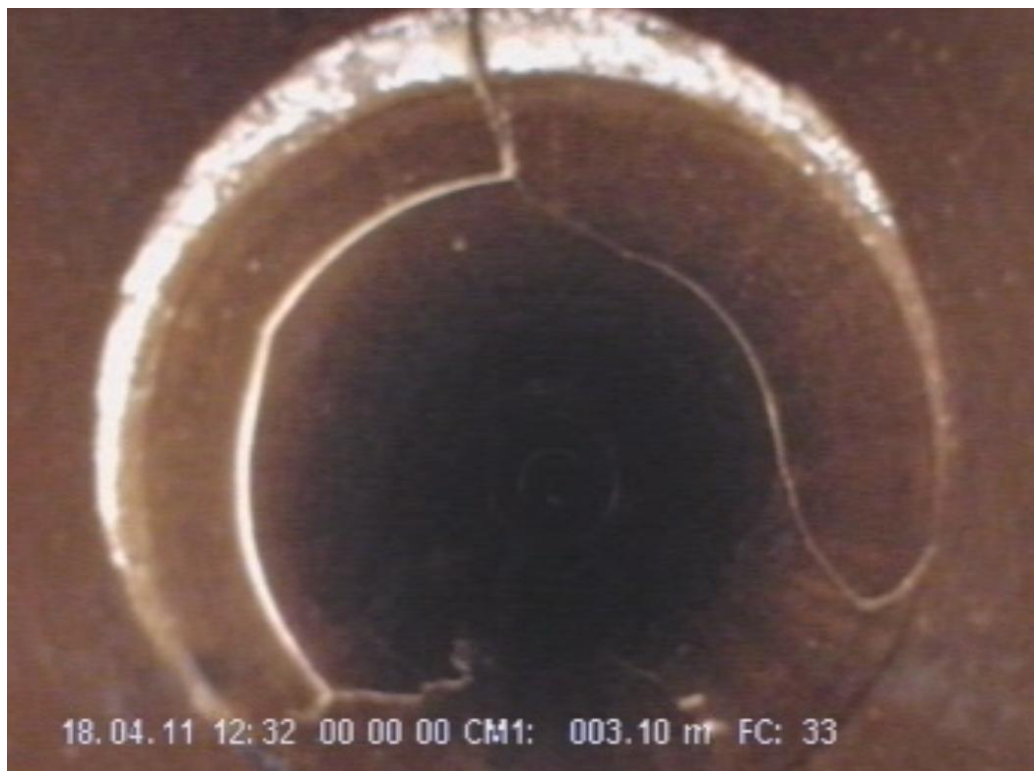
Fissuras no colector na Rua Virgílio Arruda, Santarém – Arquivo Pessoal
